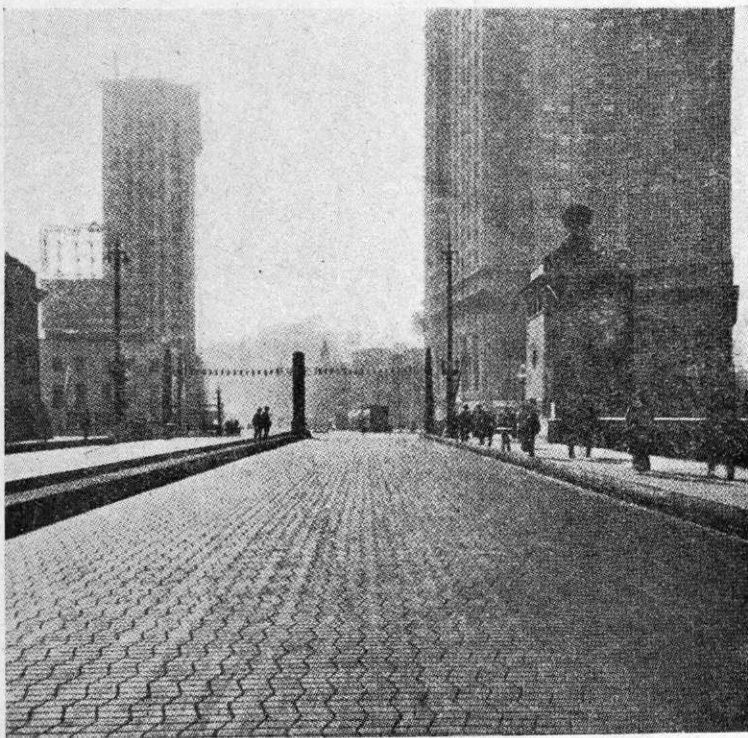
Chaussée du Pont Michigan à Chicago.
